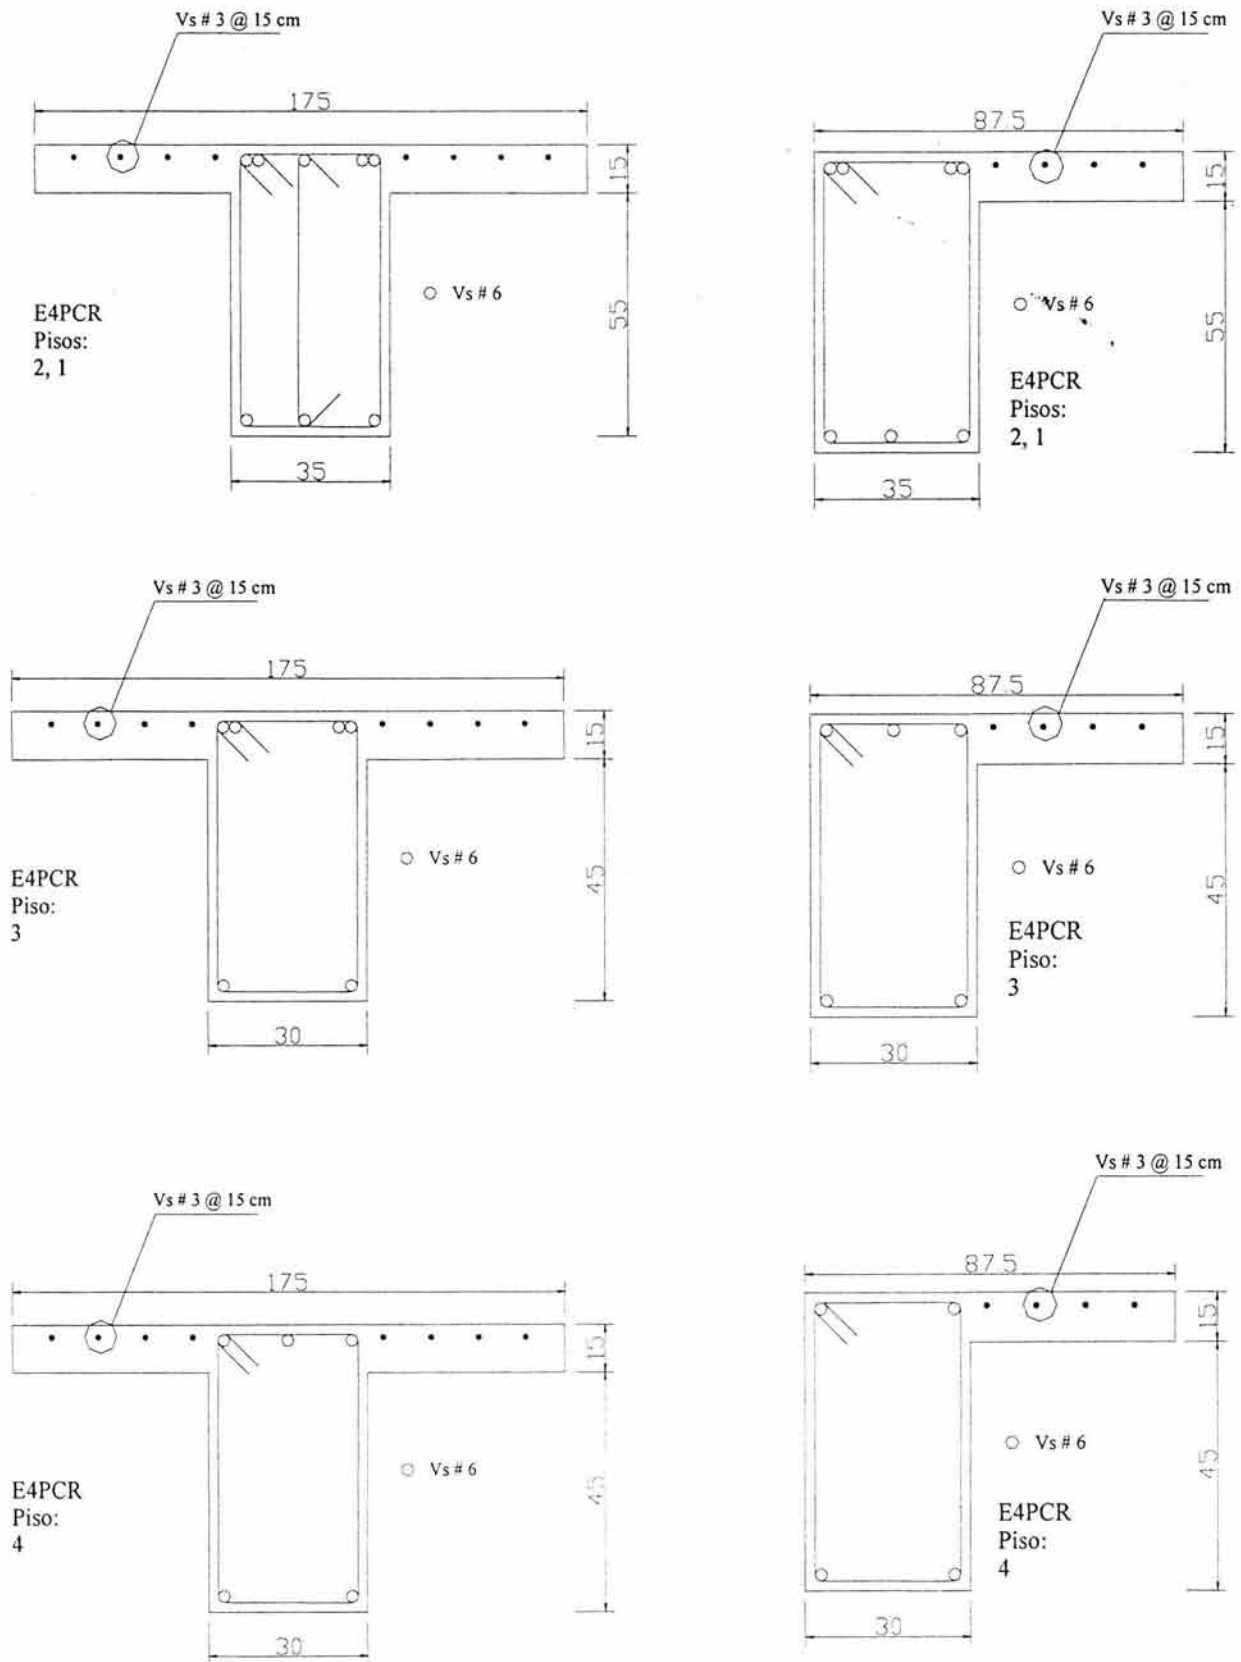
Detallado de vigas en edificio de cuatro niveles.
